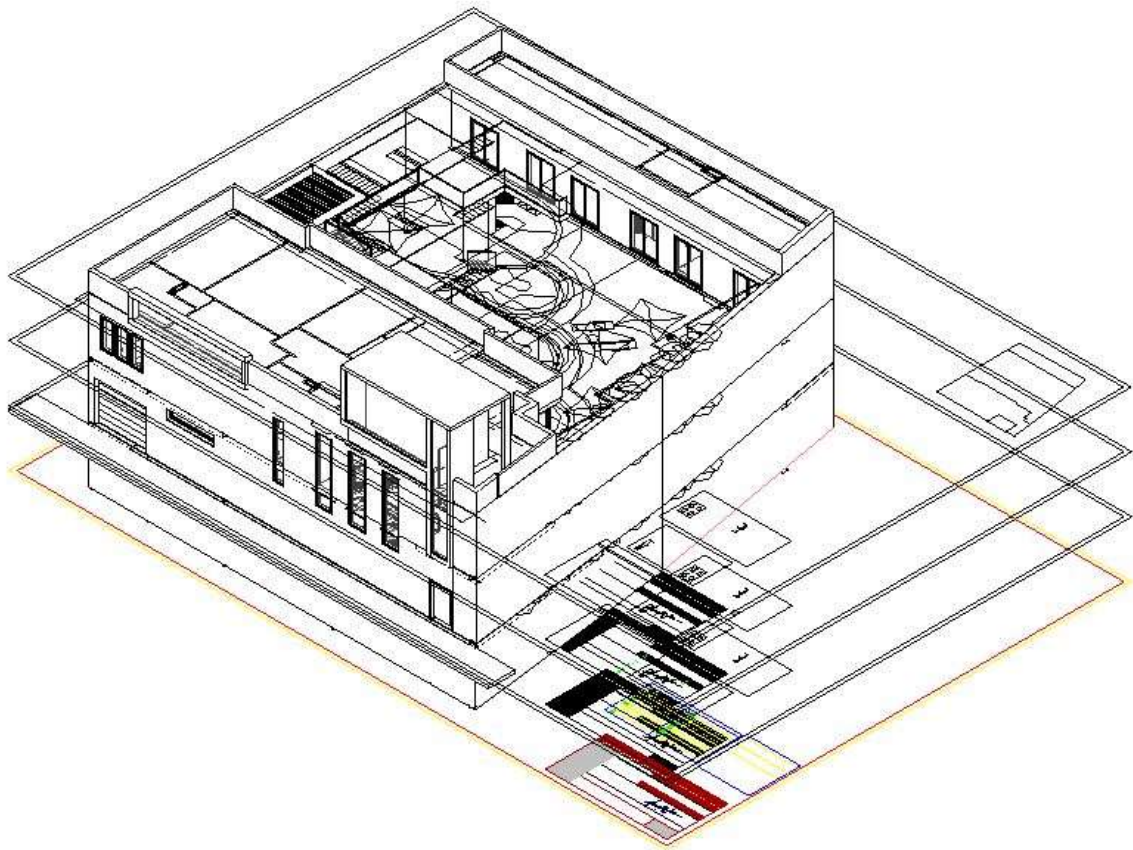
Levantamiento del modelo tridimensional desde planos CAD. Fuente propia. 2016
